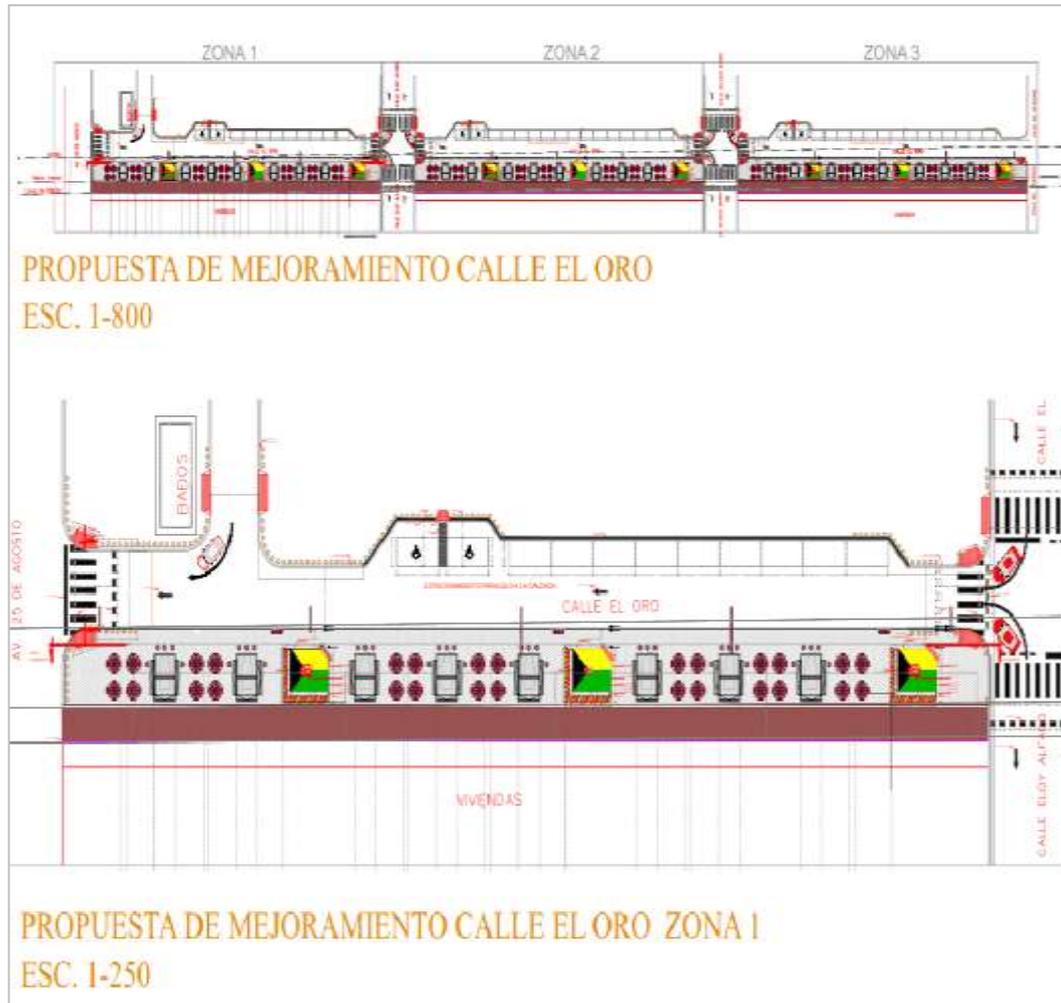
Propuesta de mejoramiento calle el Oro del Cantón La Troncal
